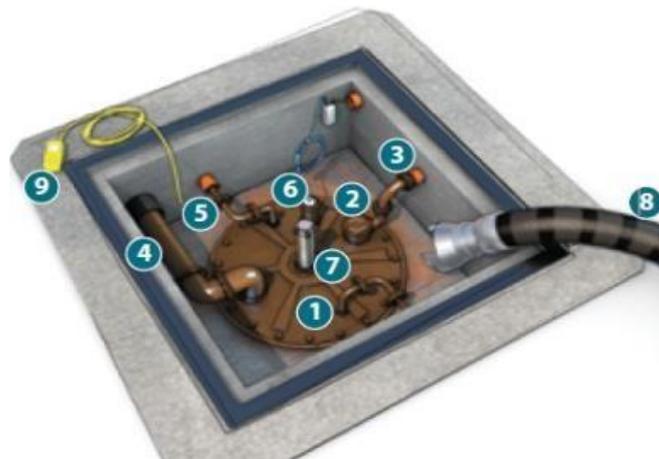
Vue d'ensemble des éléments d'un plateau de cuve avant son ouverture.
